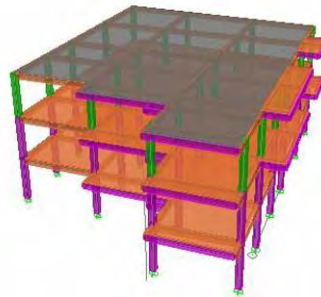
Modelo Estructural – Estructura actual con ampliación - vista general
